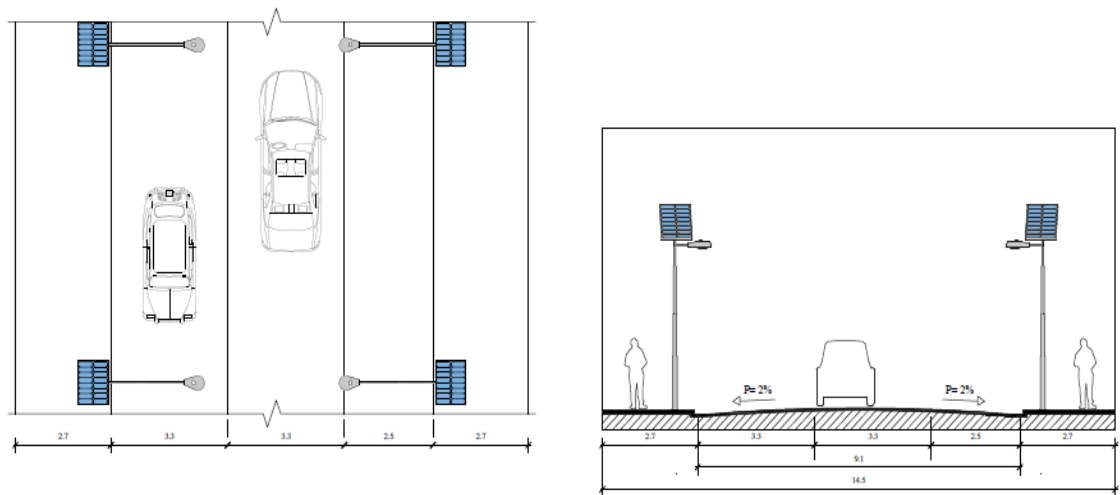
Planta y Sección de vialidad local propuesta en el Casco histórico
